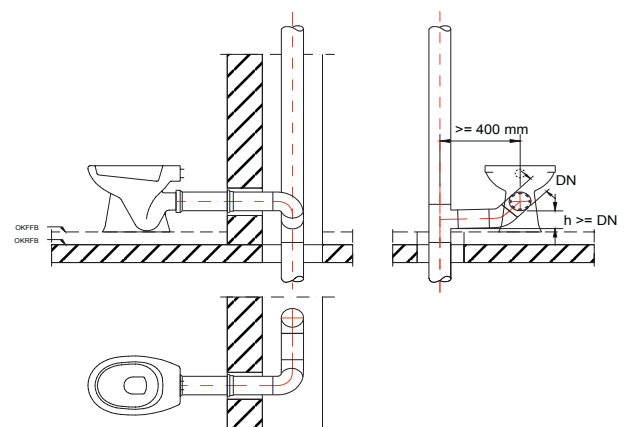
Anschluss eines stehenden Klosetts an eine Falleitung
